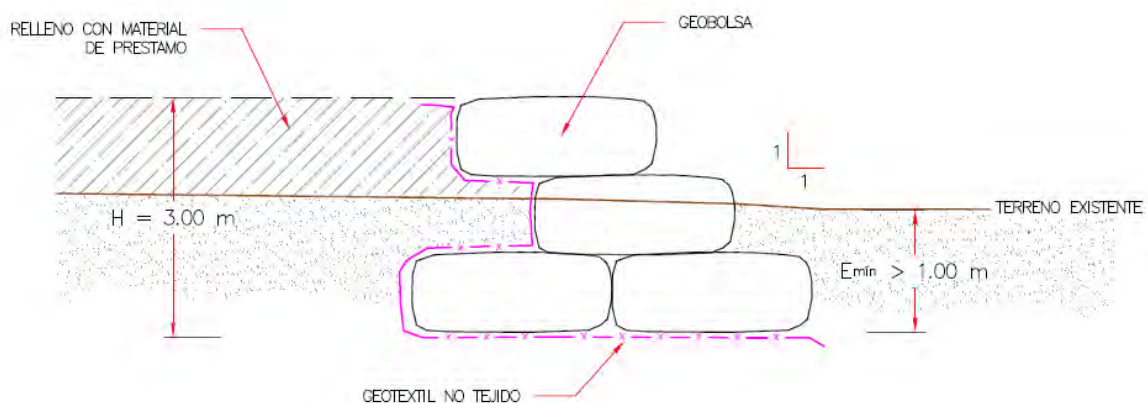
Colocación del geotextil no tejido, perfil de diseño de la geoestructura.
